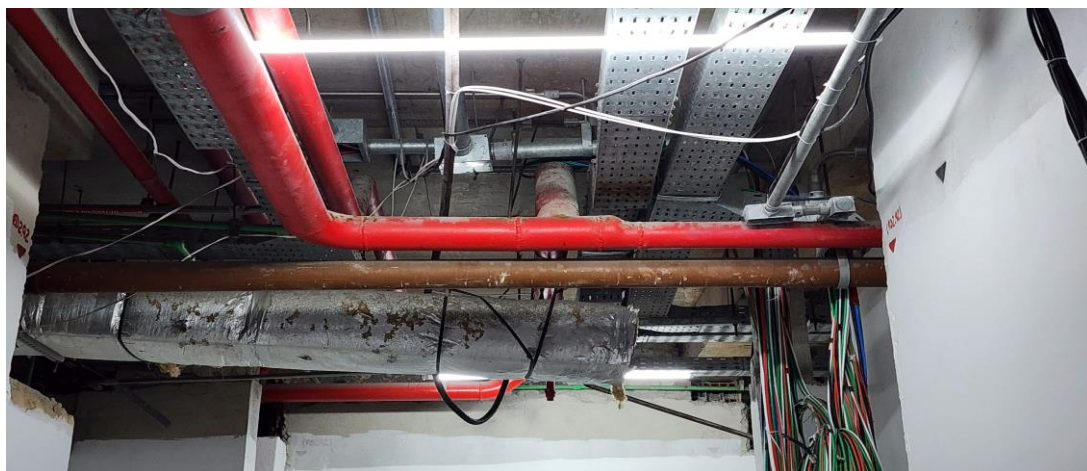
Demonstração da Patologia da Tubulação de aço galvanizado de 100 mm – 2º Subsolo
